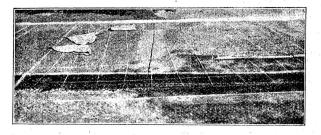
Neue Betonstraße Mit Witumuls gefüllte Querfuge. Sandabbechung.
